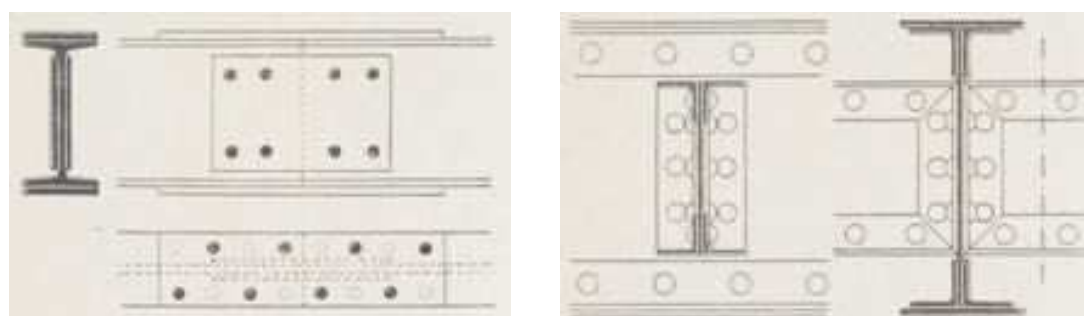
Bilan de dispositions constructives d'assemblages en simple et double recouvrement (Collette, 2014).
